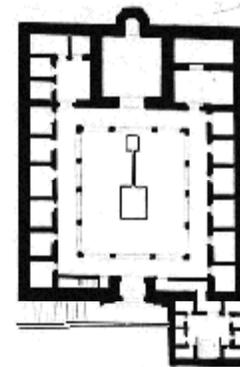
مسقط أفقي للدور الأرضي للمدرسة المسيحية
